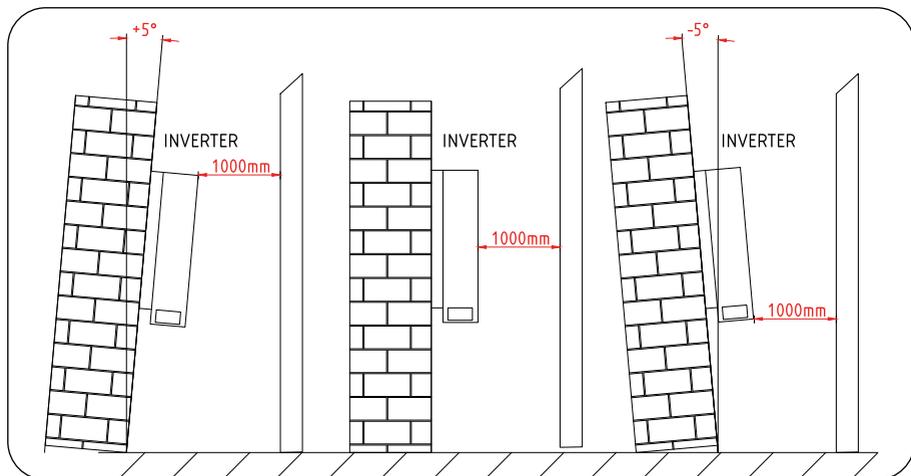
Spazio di installazione dell'inverter (distanze minime), vista laterale
